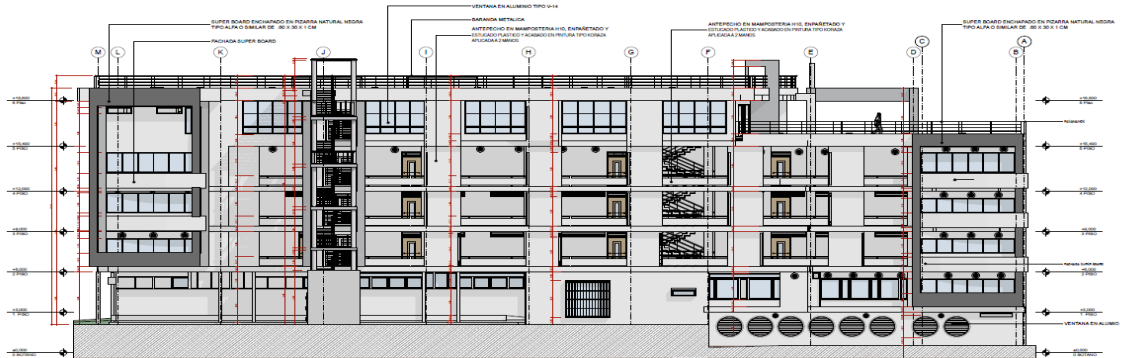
Fachada sur del edificio de Ingeniería Eléctrica.
